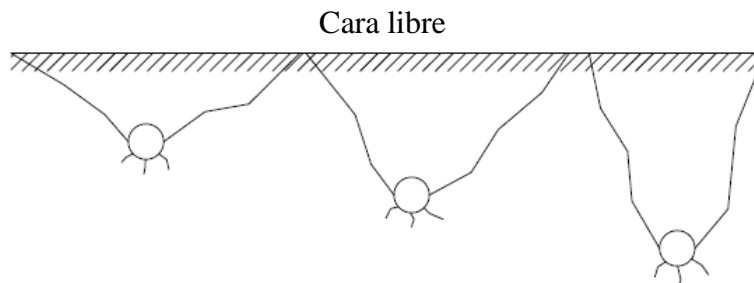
Grietas radiales hacia la cara libre
